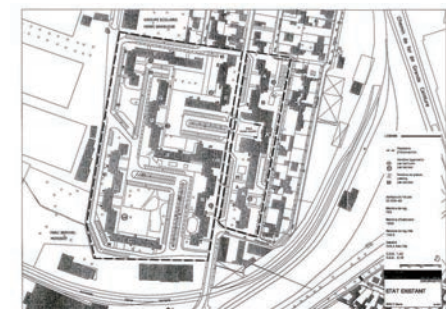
シテ・ド・レトワル団地 平面図 (団地更新前)<sup>9)</sup>
